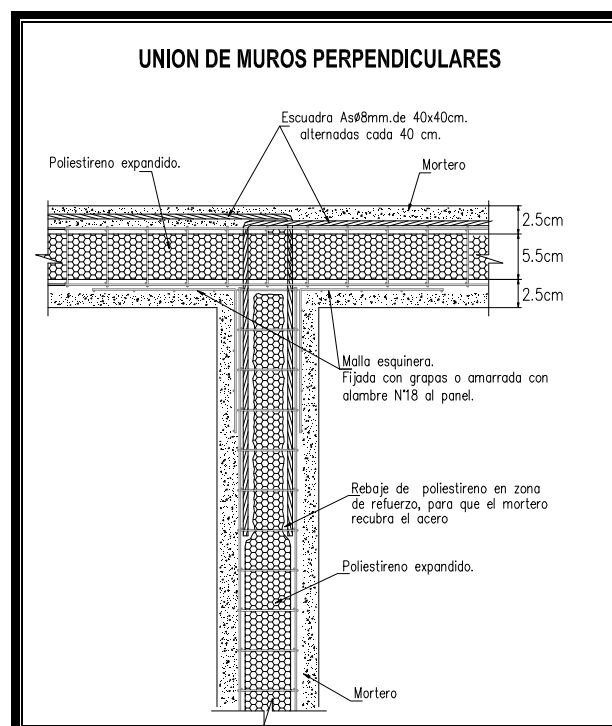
Detalle de armado de acero de refuerzo en muros perpendiculares
